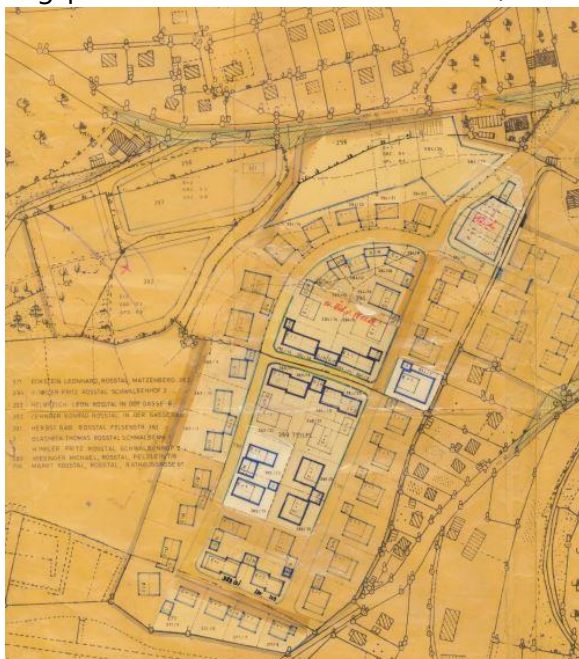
Ausschnitt BP Nr. 1 „Schwalbenhof“ mit Änderungen
